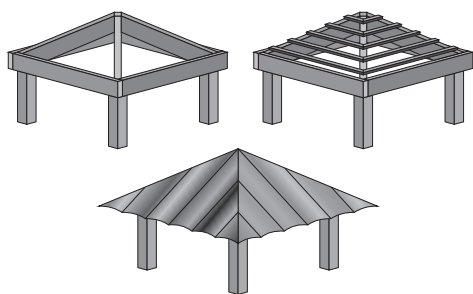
Перекрытие беседки листовым кровельным материалом
